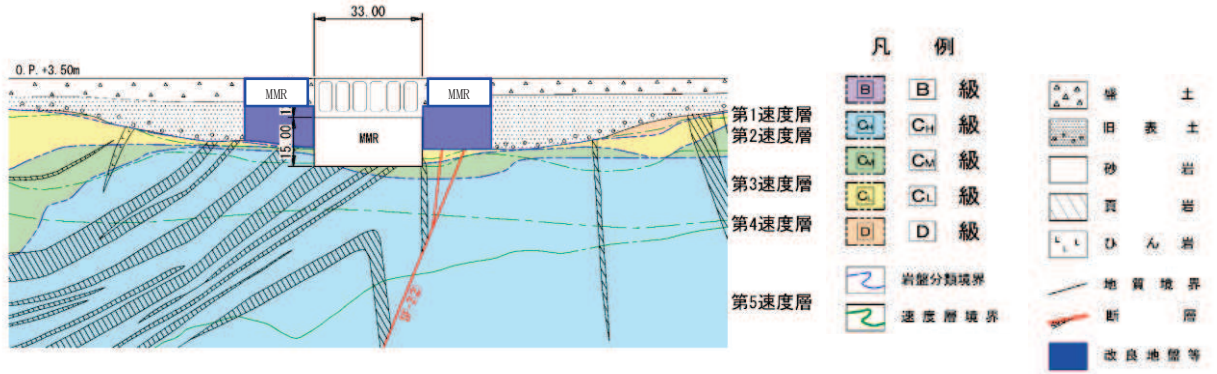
地盤改良体の配置図 (取水口, A-A 断面)
